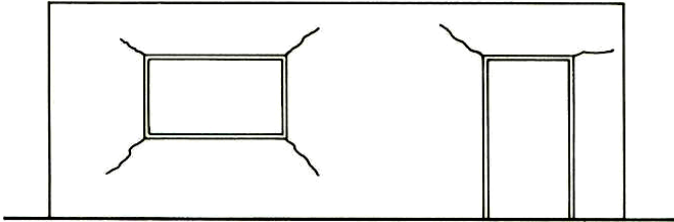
Fissuras inclinadas em paredes com aberturas sob ação de sobrecargas
